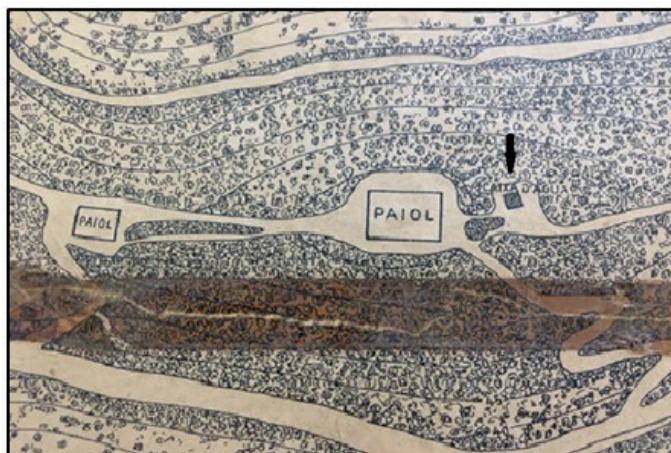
Detalhe da planta da Fortaleza de São João – Cap Volmér Augusto da Silveira – 1916
